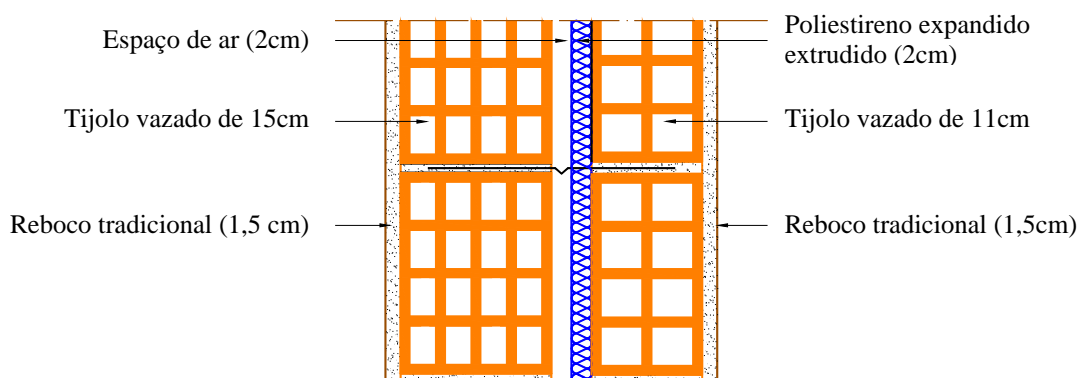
Parede dupla em alvenaria de tijolo vazado (Par1 - solução de referência)
